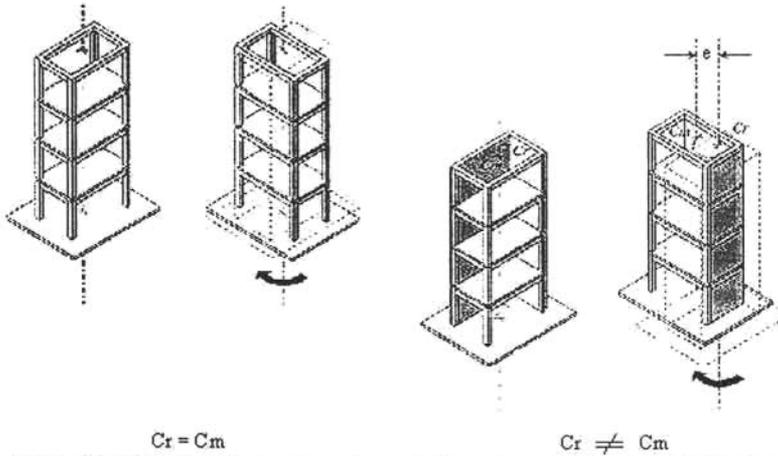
Desplazamiento del centro de rigideces con respecto al centro de masas
